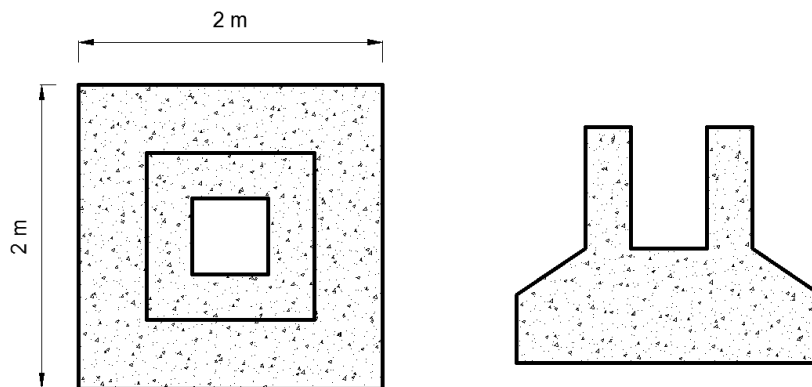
Representación esquemática en planta y corte de una zapata, con sus respectivas medidas. Fuente: elaboración propia.
